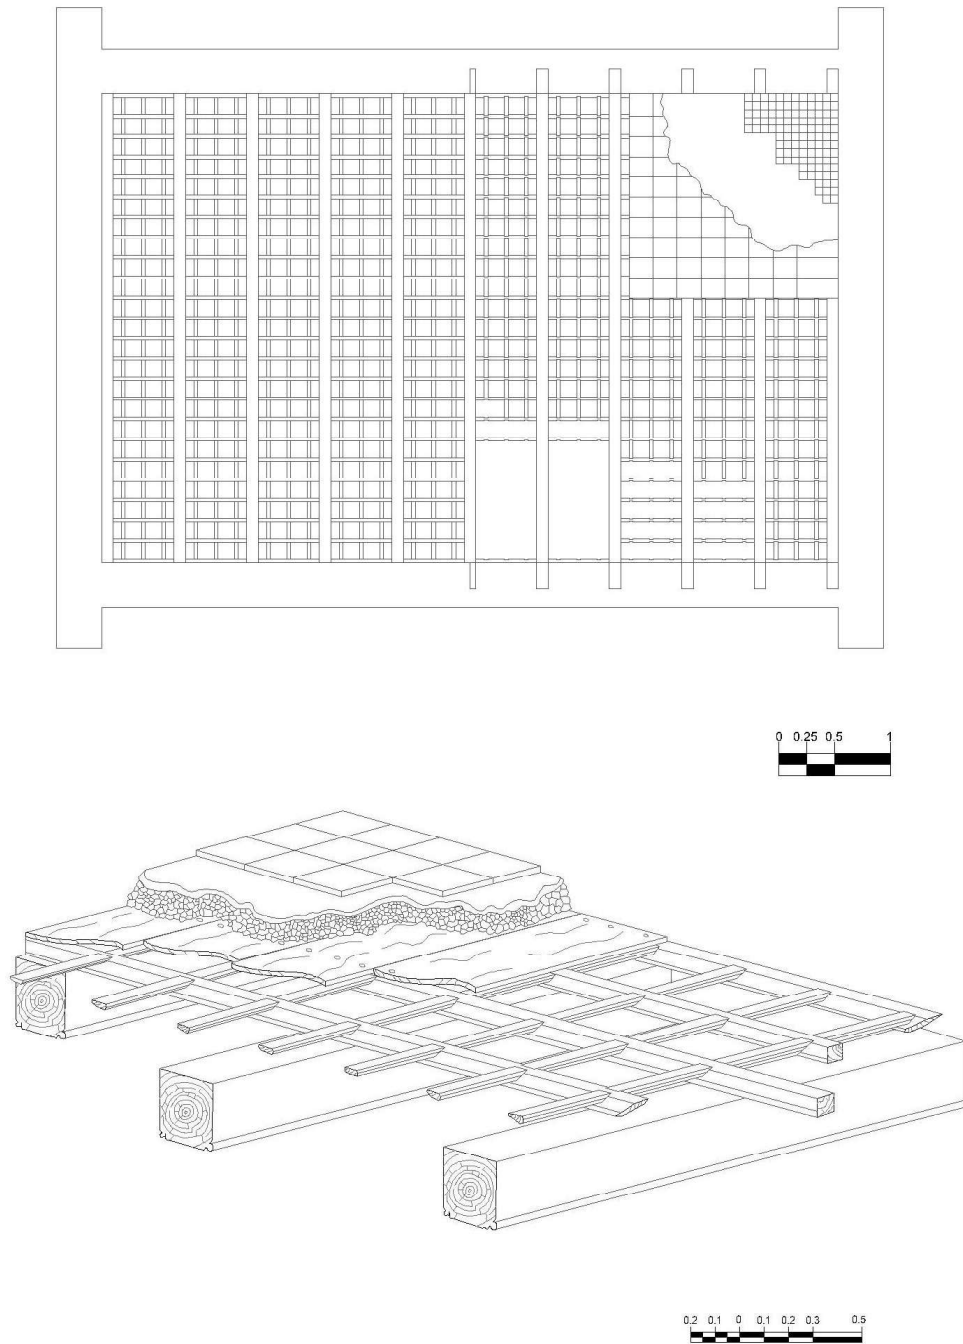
Plan plancher (en haut). Axonométrie du plancher (en bas)
